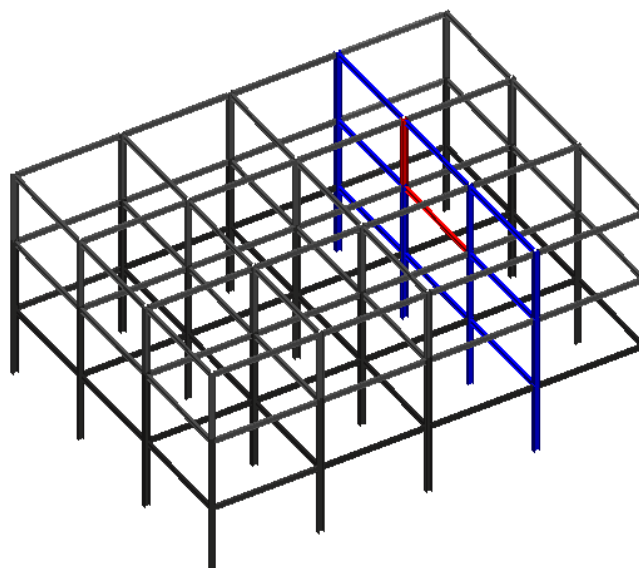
Representação 3D dos elementos em estudo – pórtico a azul e elementos a vermelho
